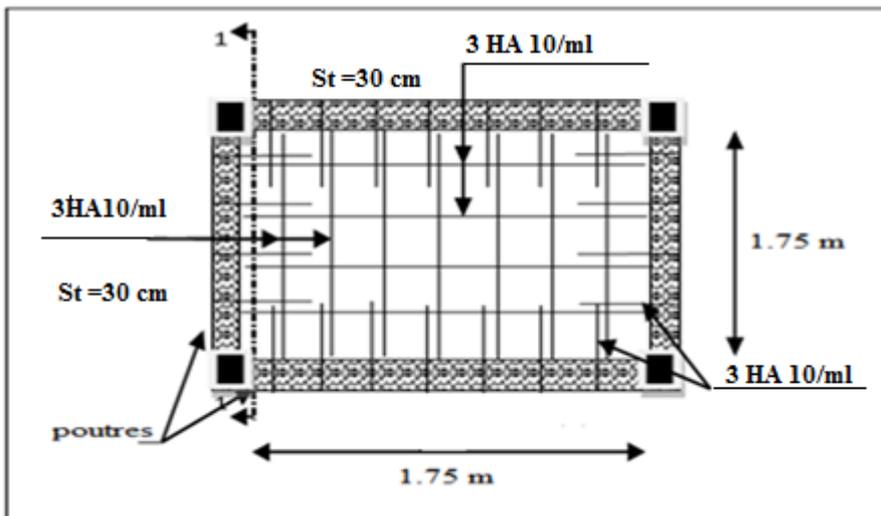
Schéma de ferrailage de la dalle sur 4 appuis.
